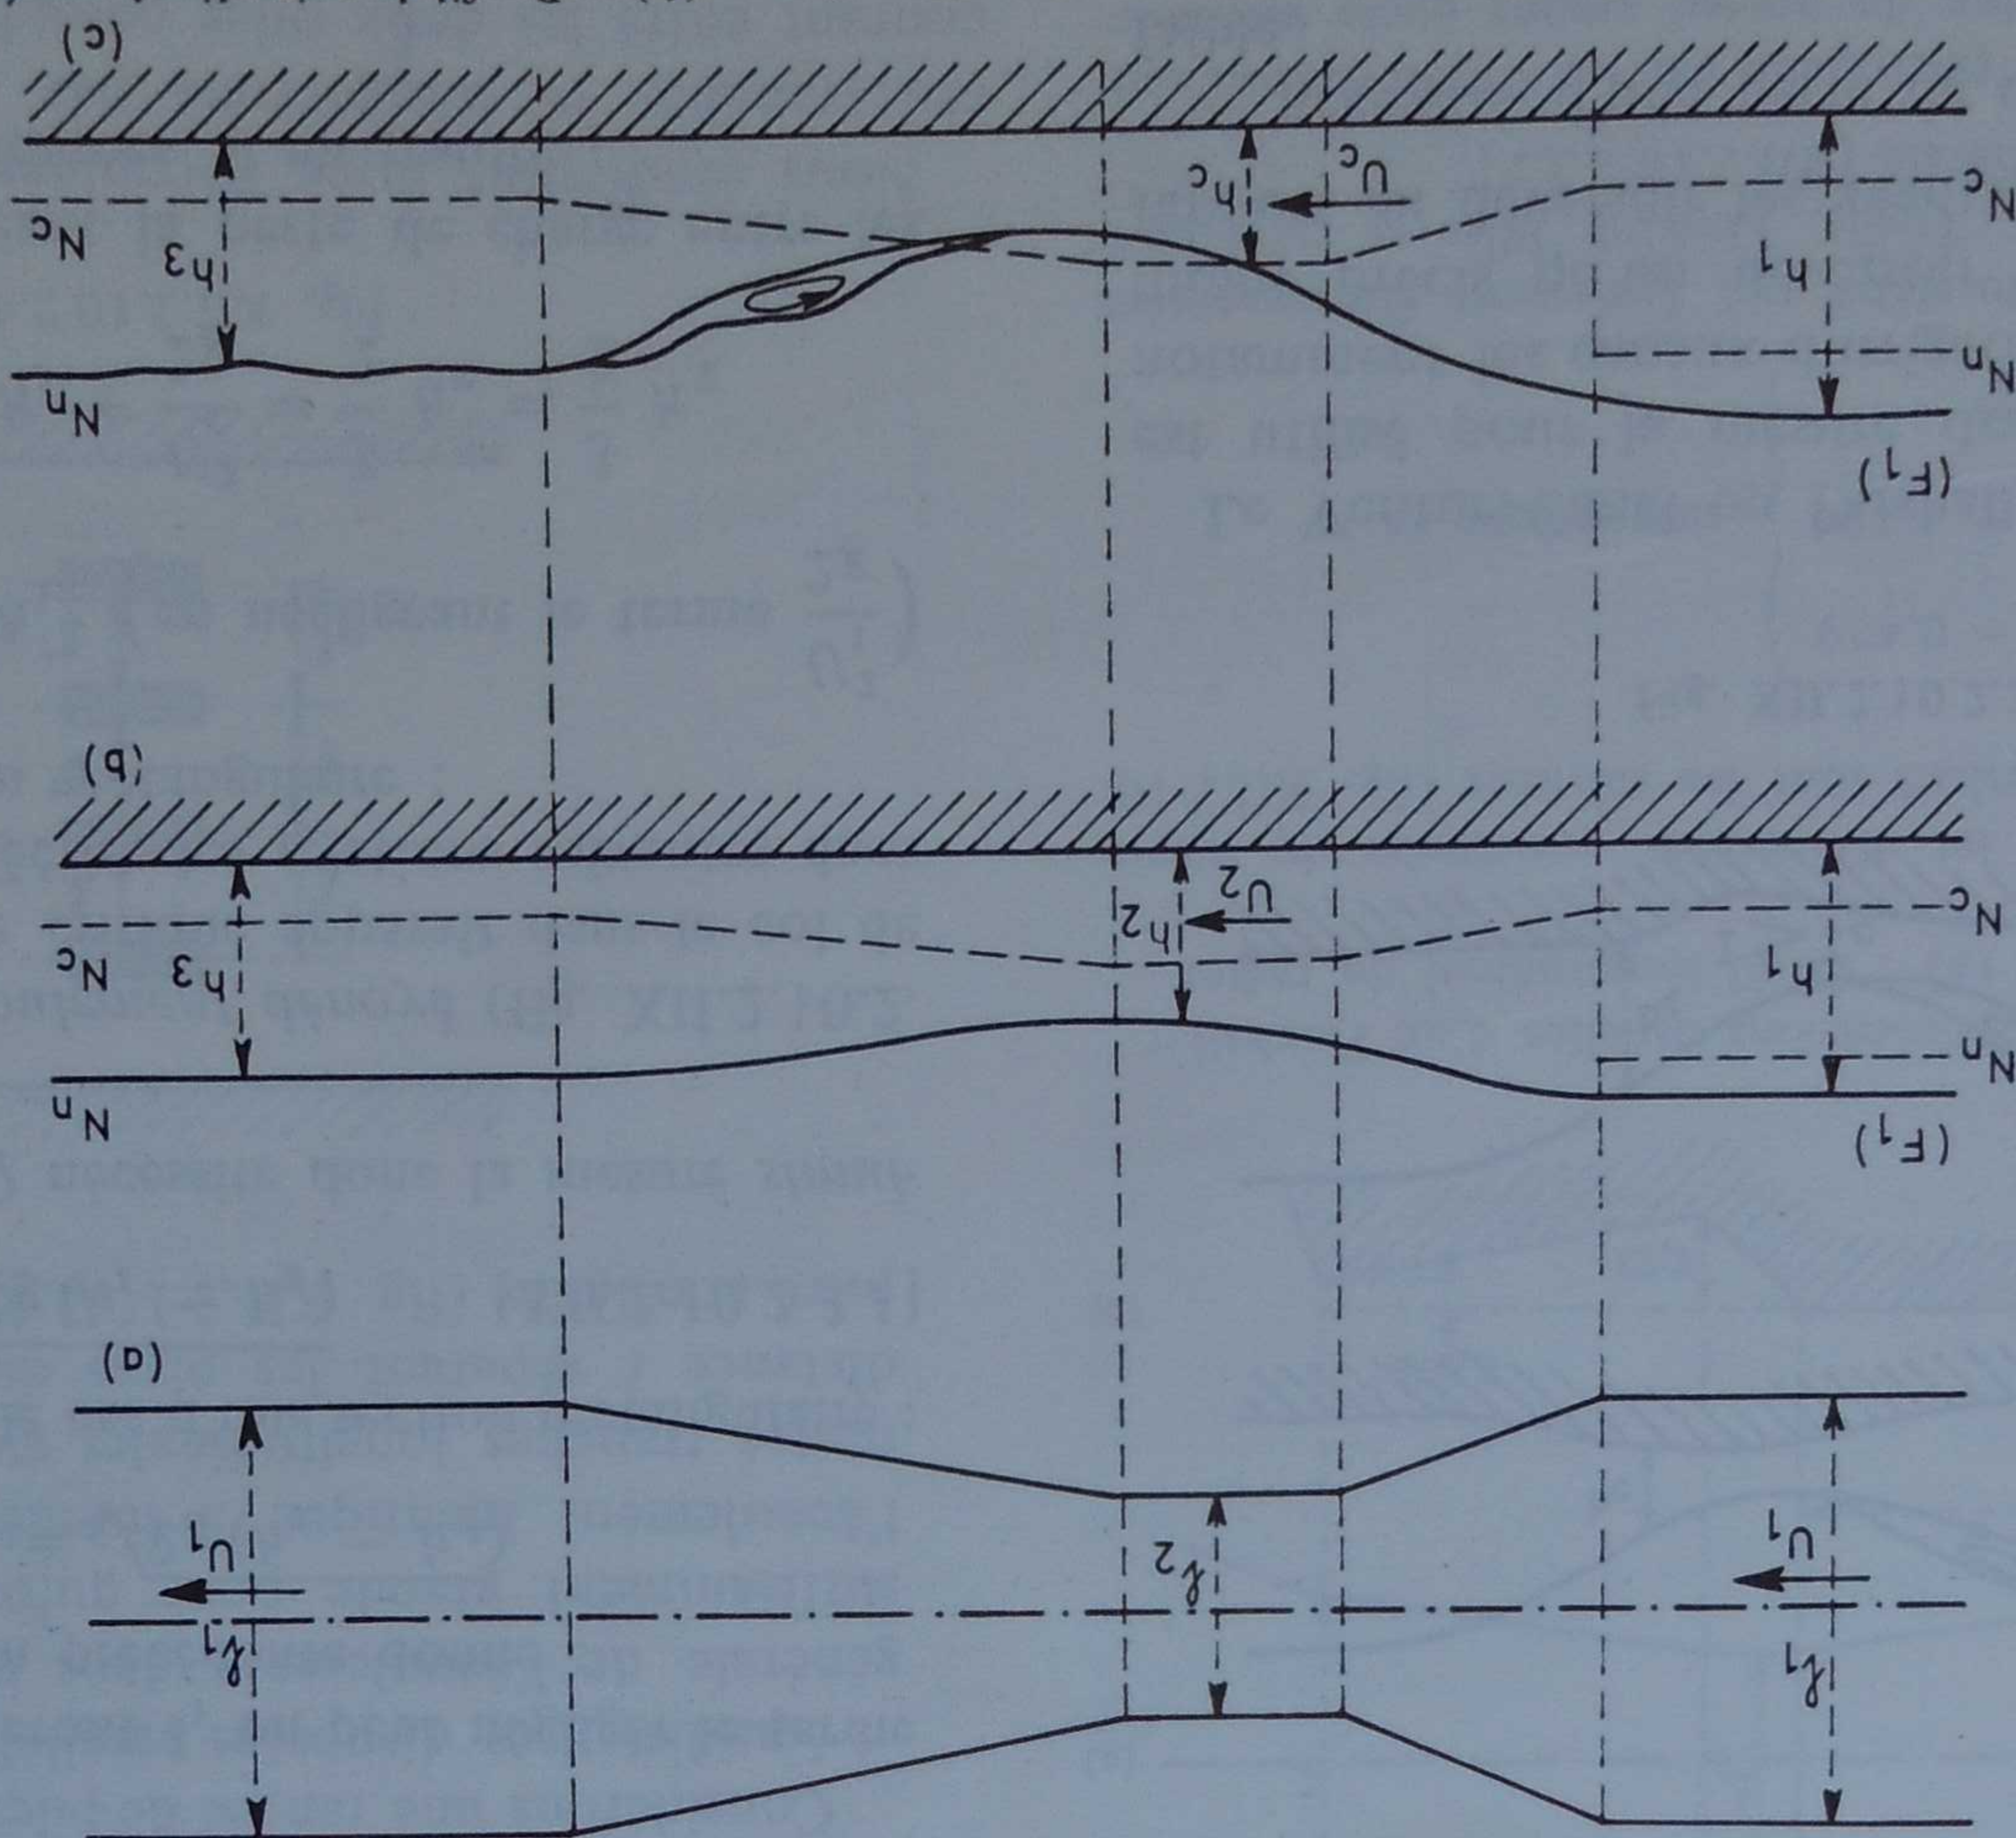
Canal-Venturi ou Parshall ; (a) : Vue en plan ; (b) : Profil longitudinal en écoulement noyé ; (c) : Profil longitudinal en écoulement dénoyé.
